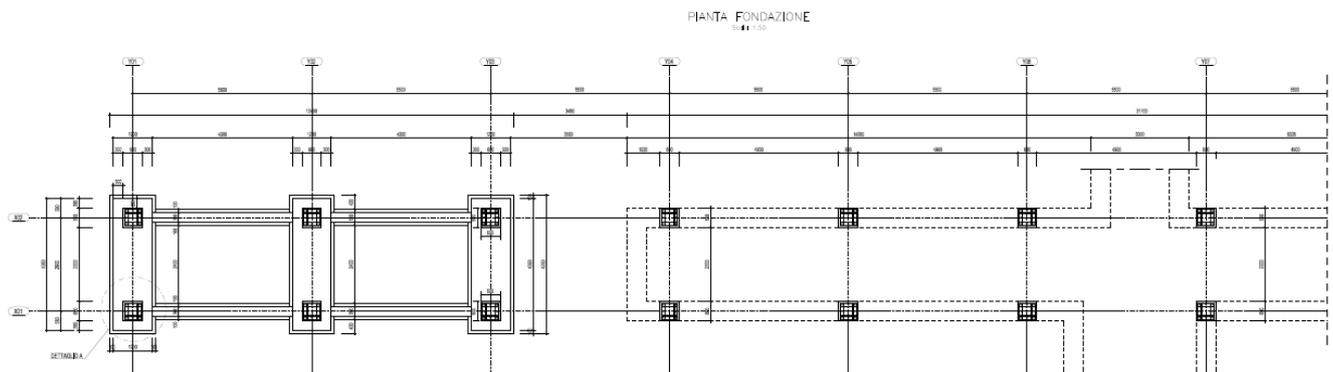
Pensiline – Stralcio Pianta Fondazioni - Pensilina Sud
